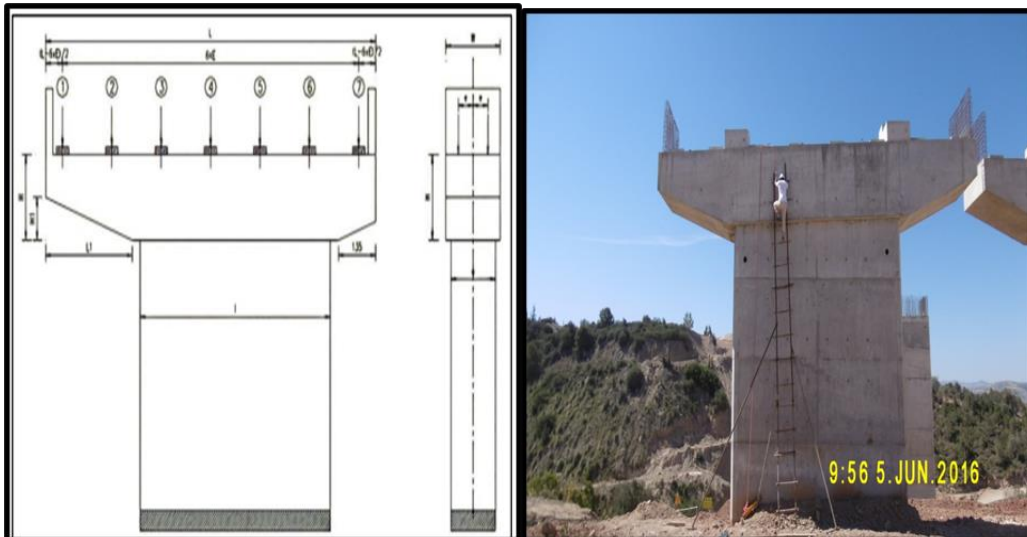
Plan détaillant la géométrie et une photo du chevêtre
